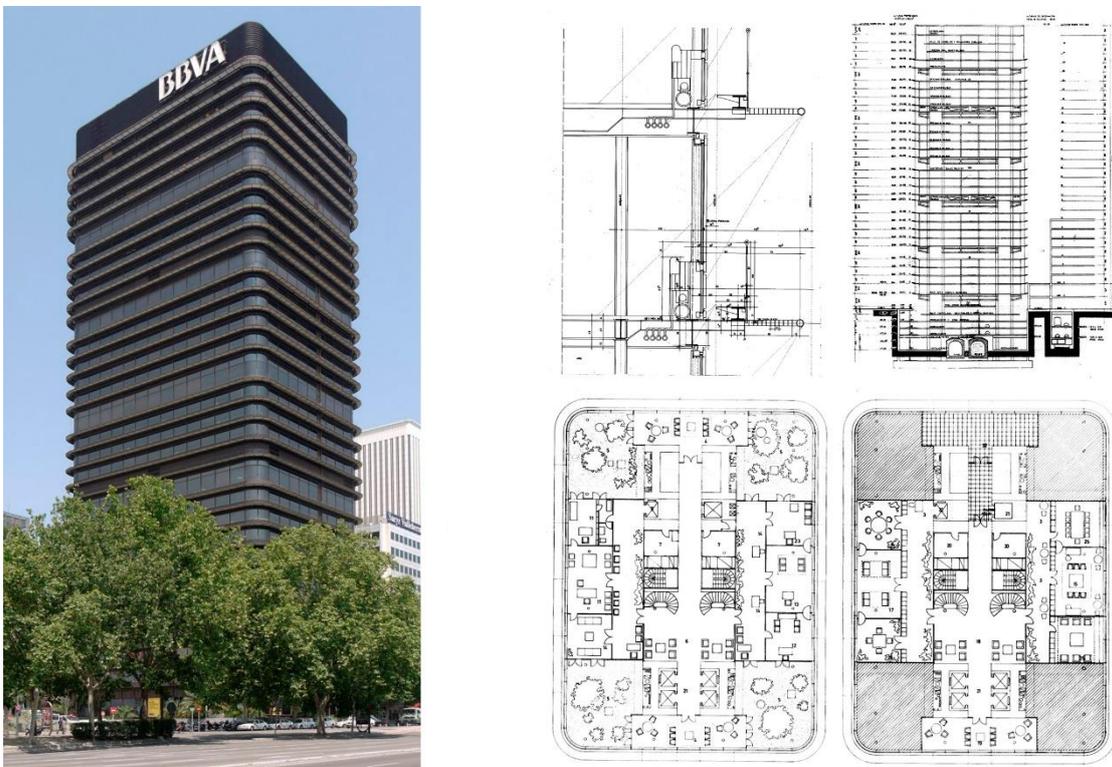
Fachada, planta tipo, sección y detalle constructivo.
